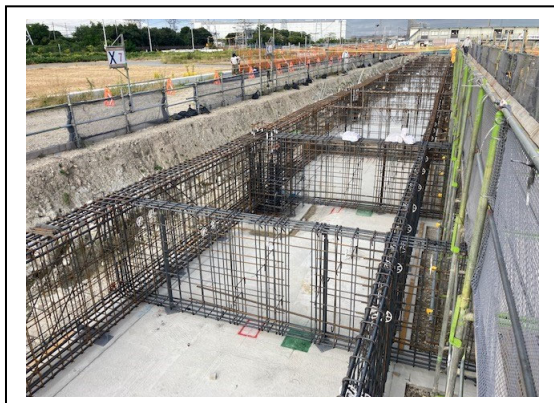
2. 3b 基礎躯体施工状況（管理棟）
